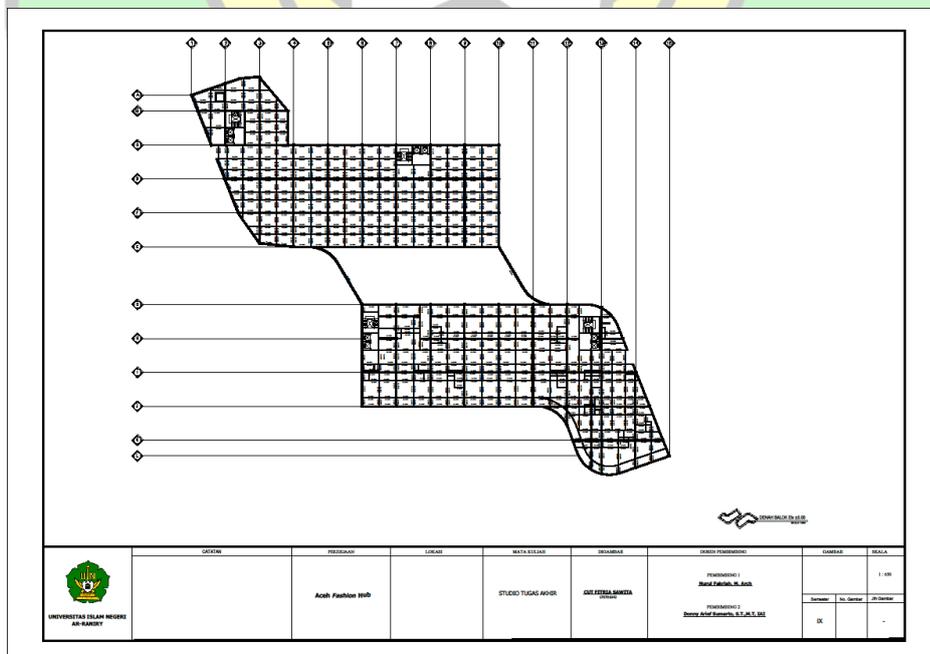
Denah Rencana Kolom Elv 8.00 s/d 12.00
